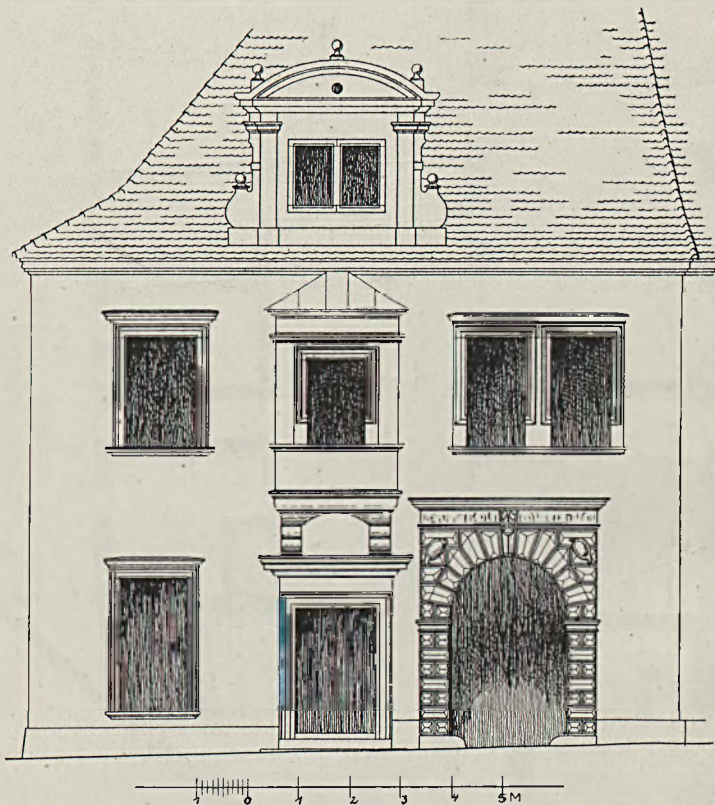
Bautzner Straße Nr. 2, Fassade.
